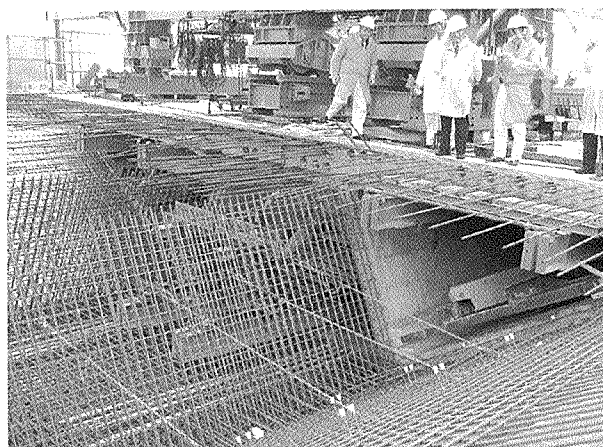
矢部川橋の主桁の施工状況（第 1 工区）
